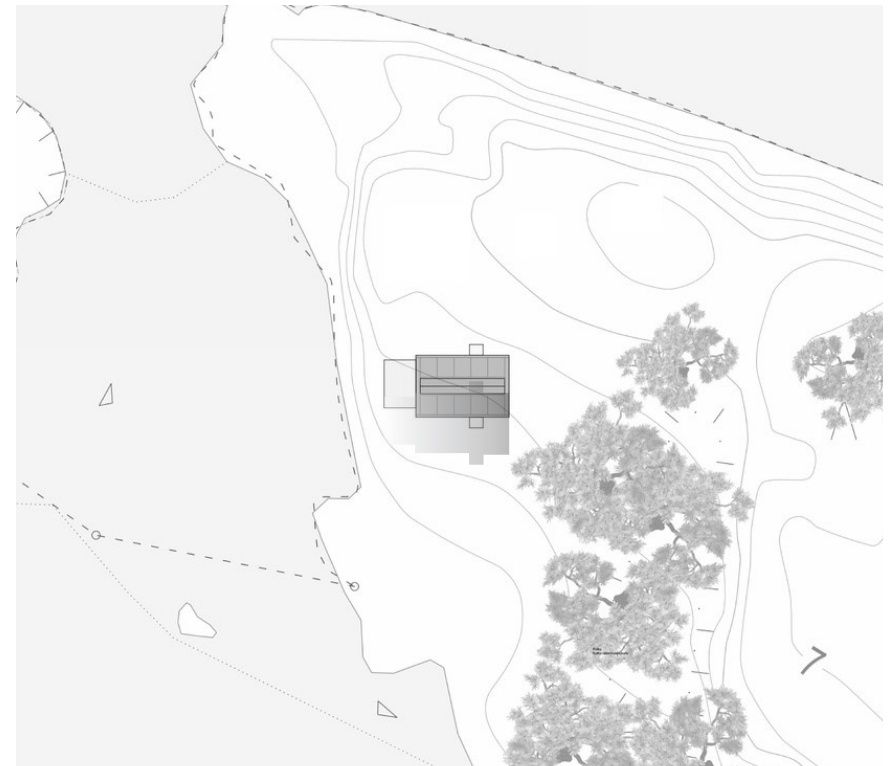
Planta de localización. Fuente: ArchDaily, 2020
